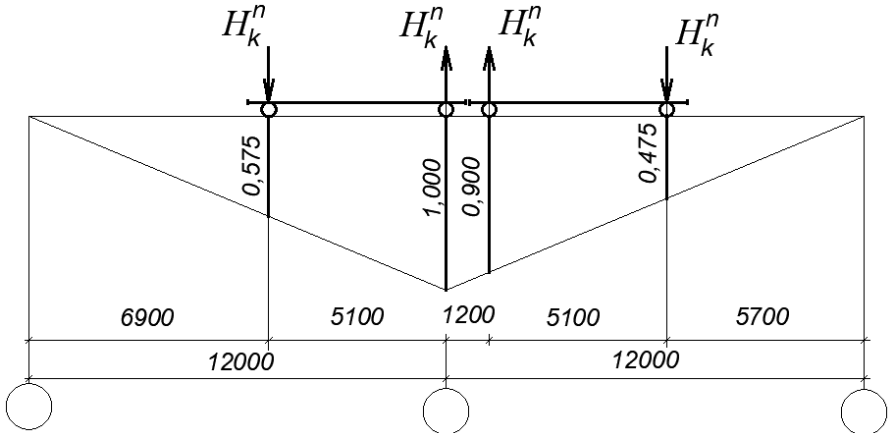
Схема для визначення горизонтальних кранових бічних навантажень від двох зближених кранів на середню опору за першим рекомендованим варіантом для правої сторони крана
